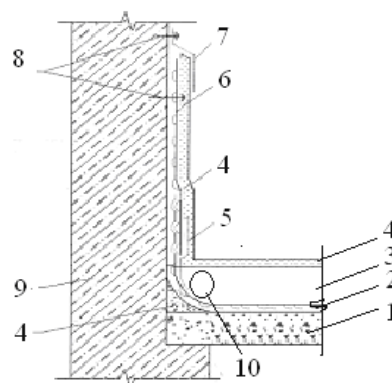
Гидроизоляция стен и пола подвала с использованием полимерных мембран:
